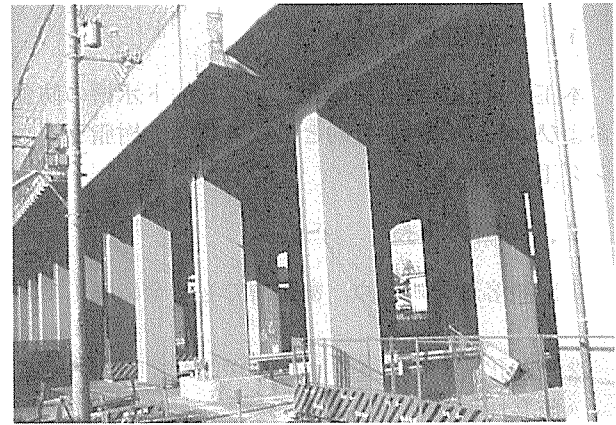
エバーコン施工例 (私鉄高架の橋脚)
